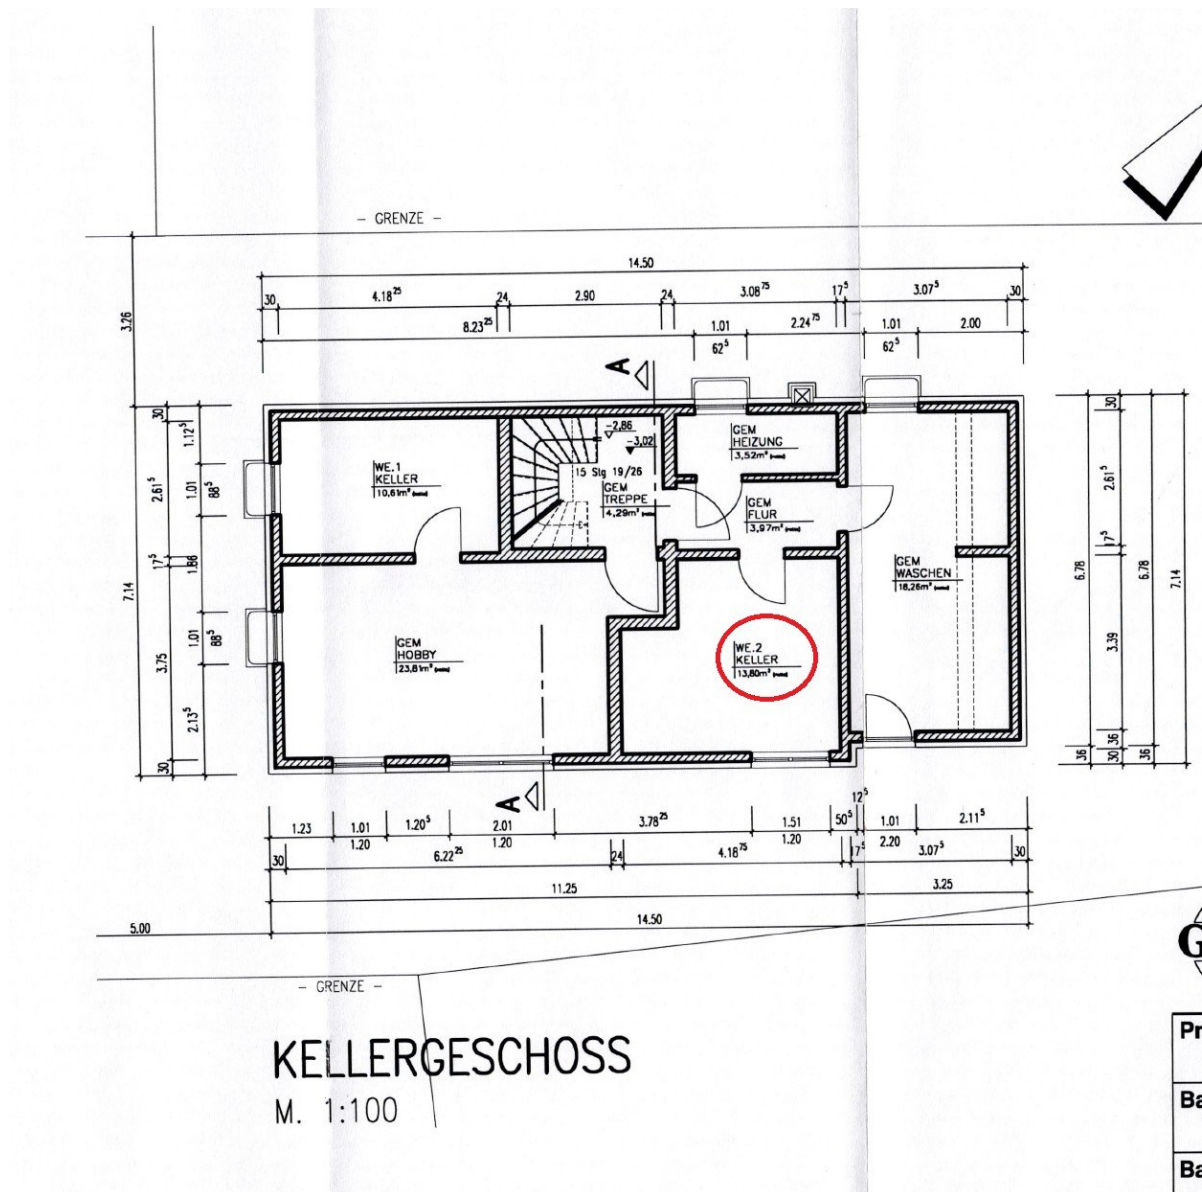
Grundriss Keller (Abgeschlossenheitspläne)
